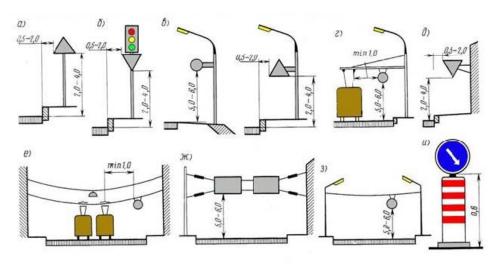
Способы установки знаков в населённых пунктах: а, б - на специальных стойках; в, г - на мачтах освещения; д - на стене здания; е - на тросах-растяжках; и - на круглой тумбе
